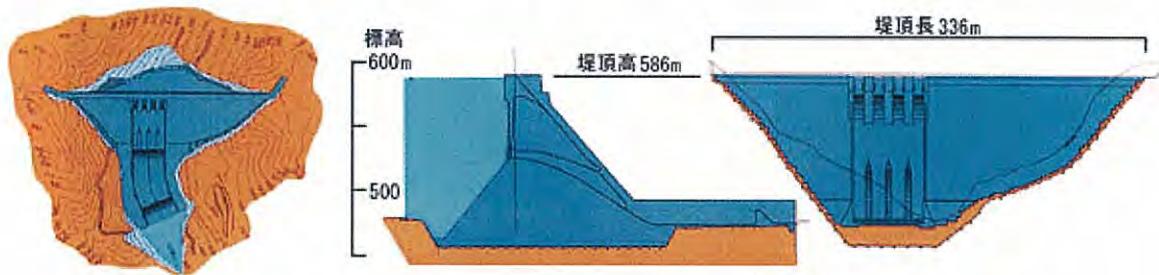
ハッ場ダムの平面図・標準断面図・下流面図（出典：ハッ場ダム工事事務所HP）
